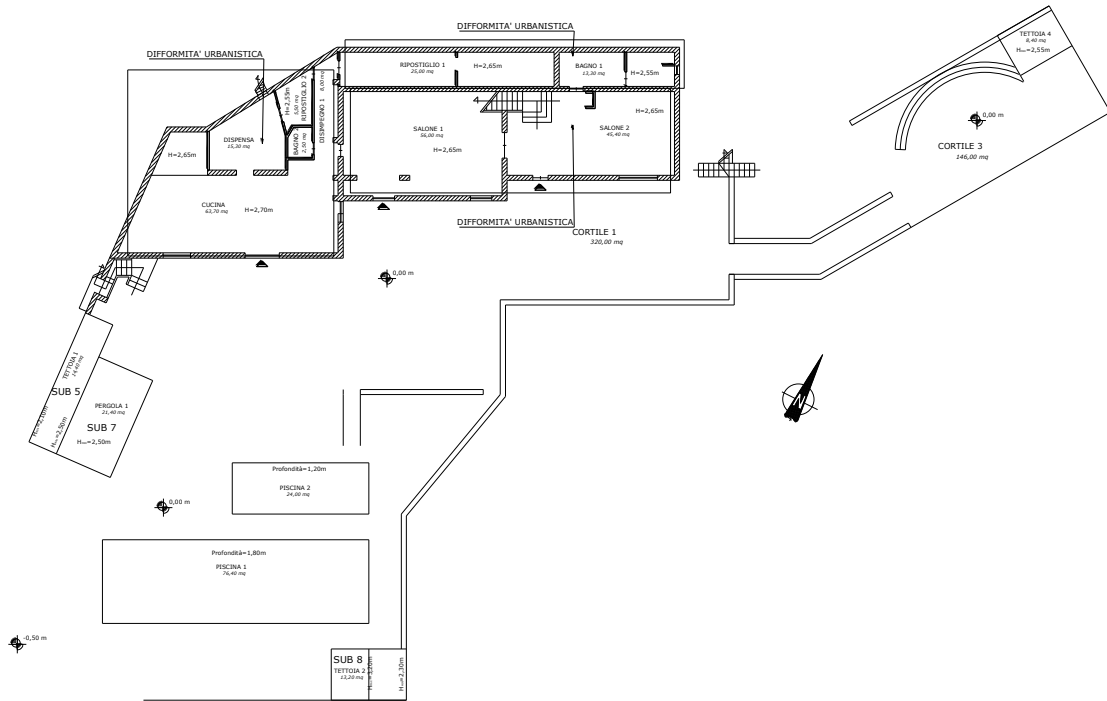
planimetria delle difformità urbanistiche del piano terra della villa
